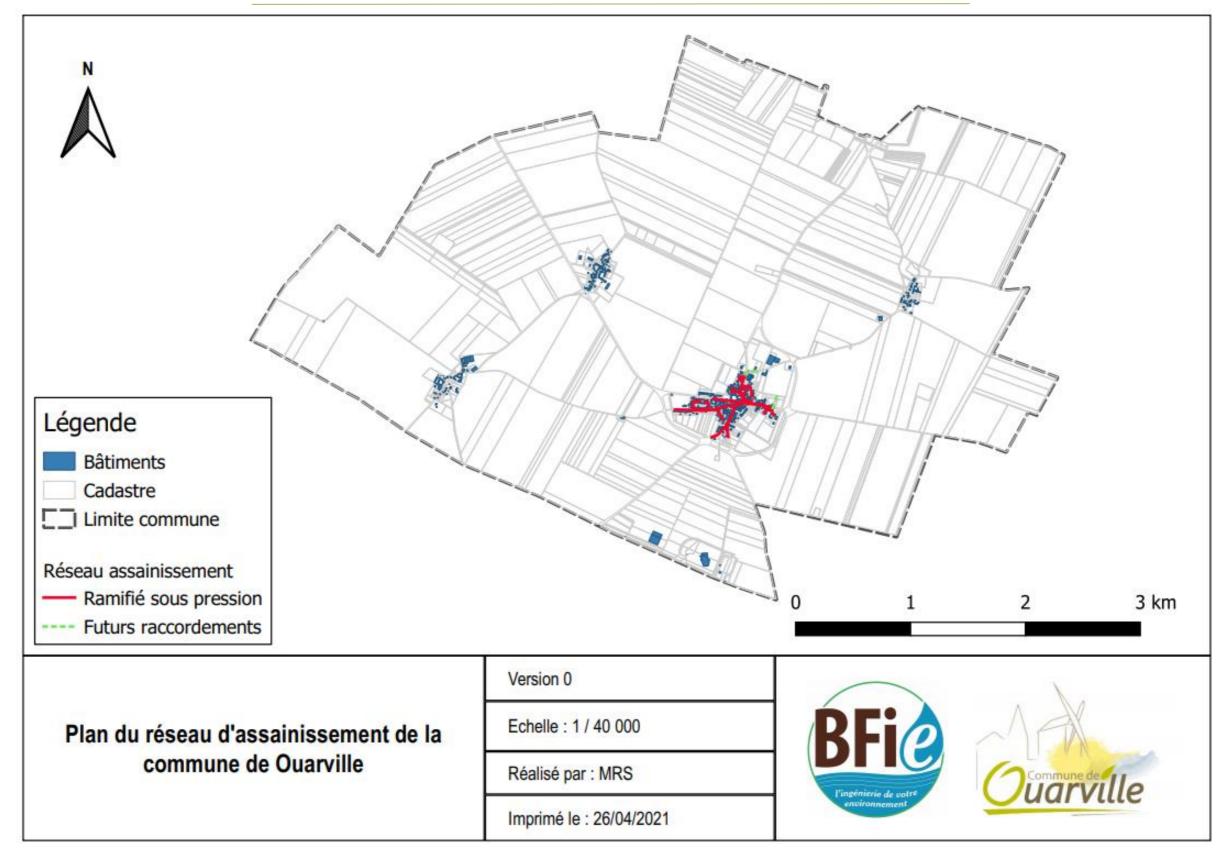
Plan du réseau d'assainissement de la commune de Ouarville
